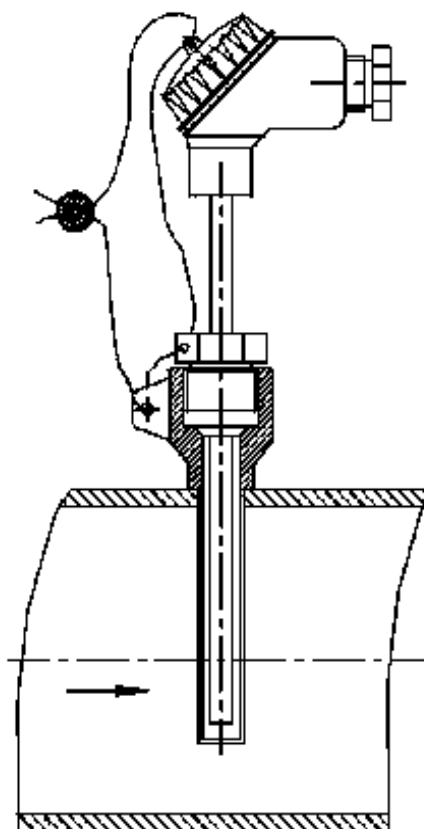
Схема монтажа термопреобразователя с защитной гильзой на трубопроводе (только для трубопроводов  $D_u > 50$ )
